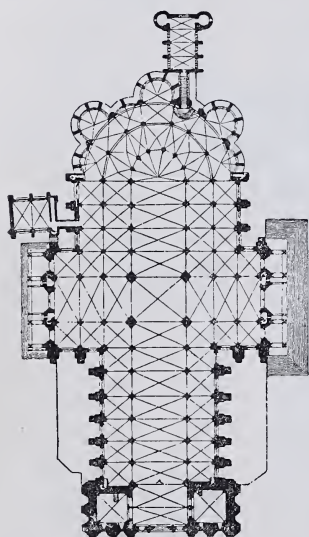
Grundriss der Kathedrale zu Chartres.
